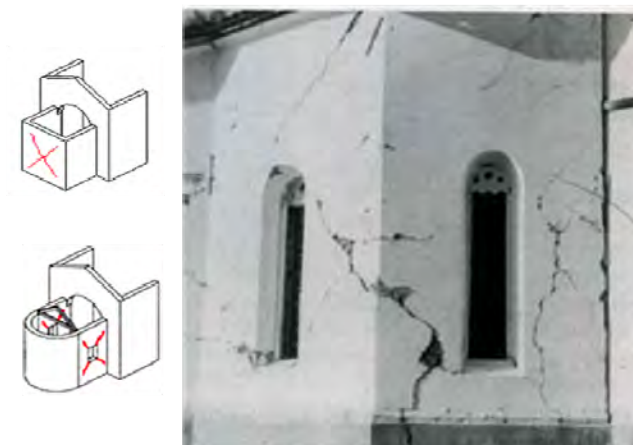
Mecanismo 17 – Fissuração por acção de corte na abside [Curti, *et al.*, 2007].
